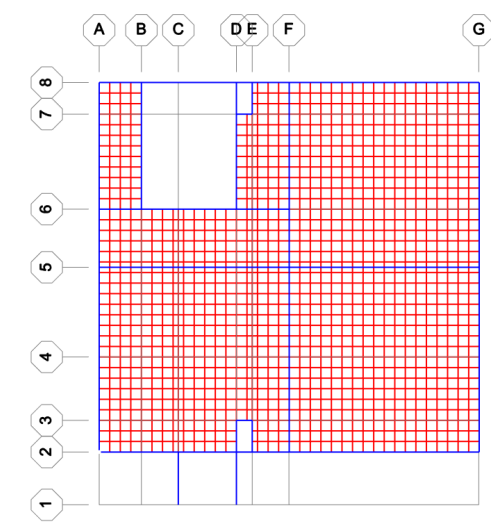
Planta Baja Discretizada _ N=+-0.00.
